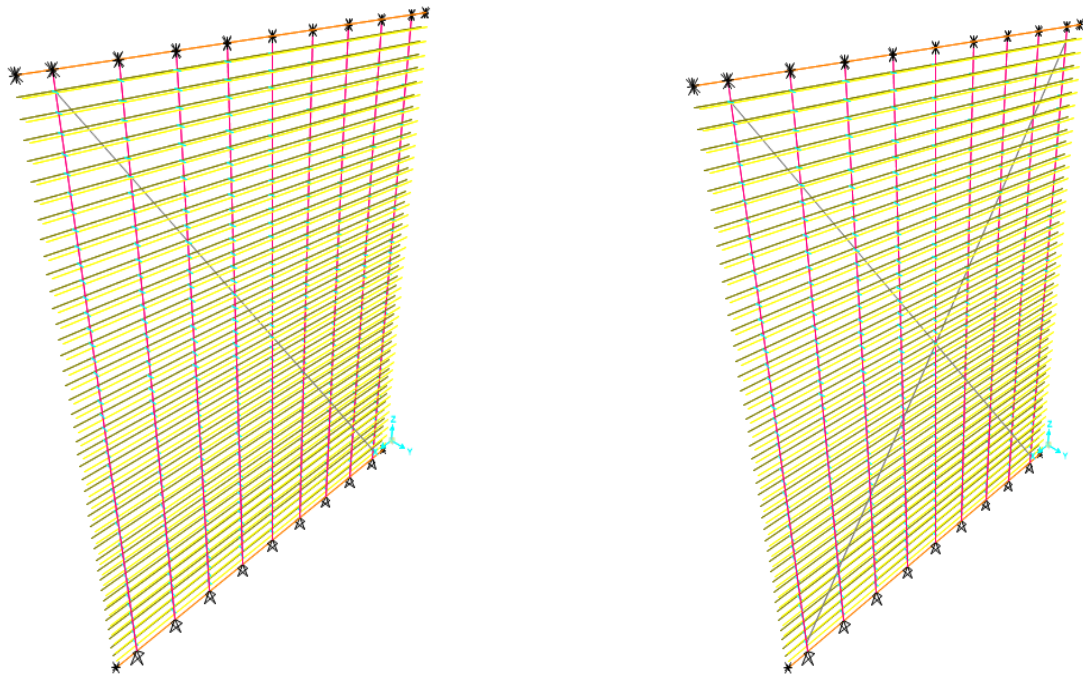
Fitas metálicas numa PTS com disposição em “\” e em “X”
